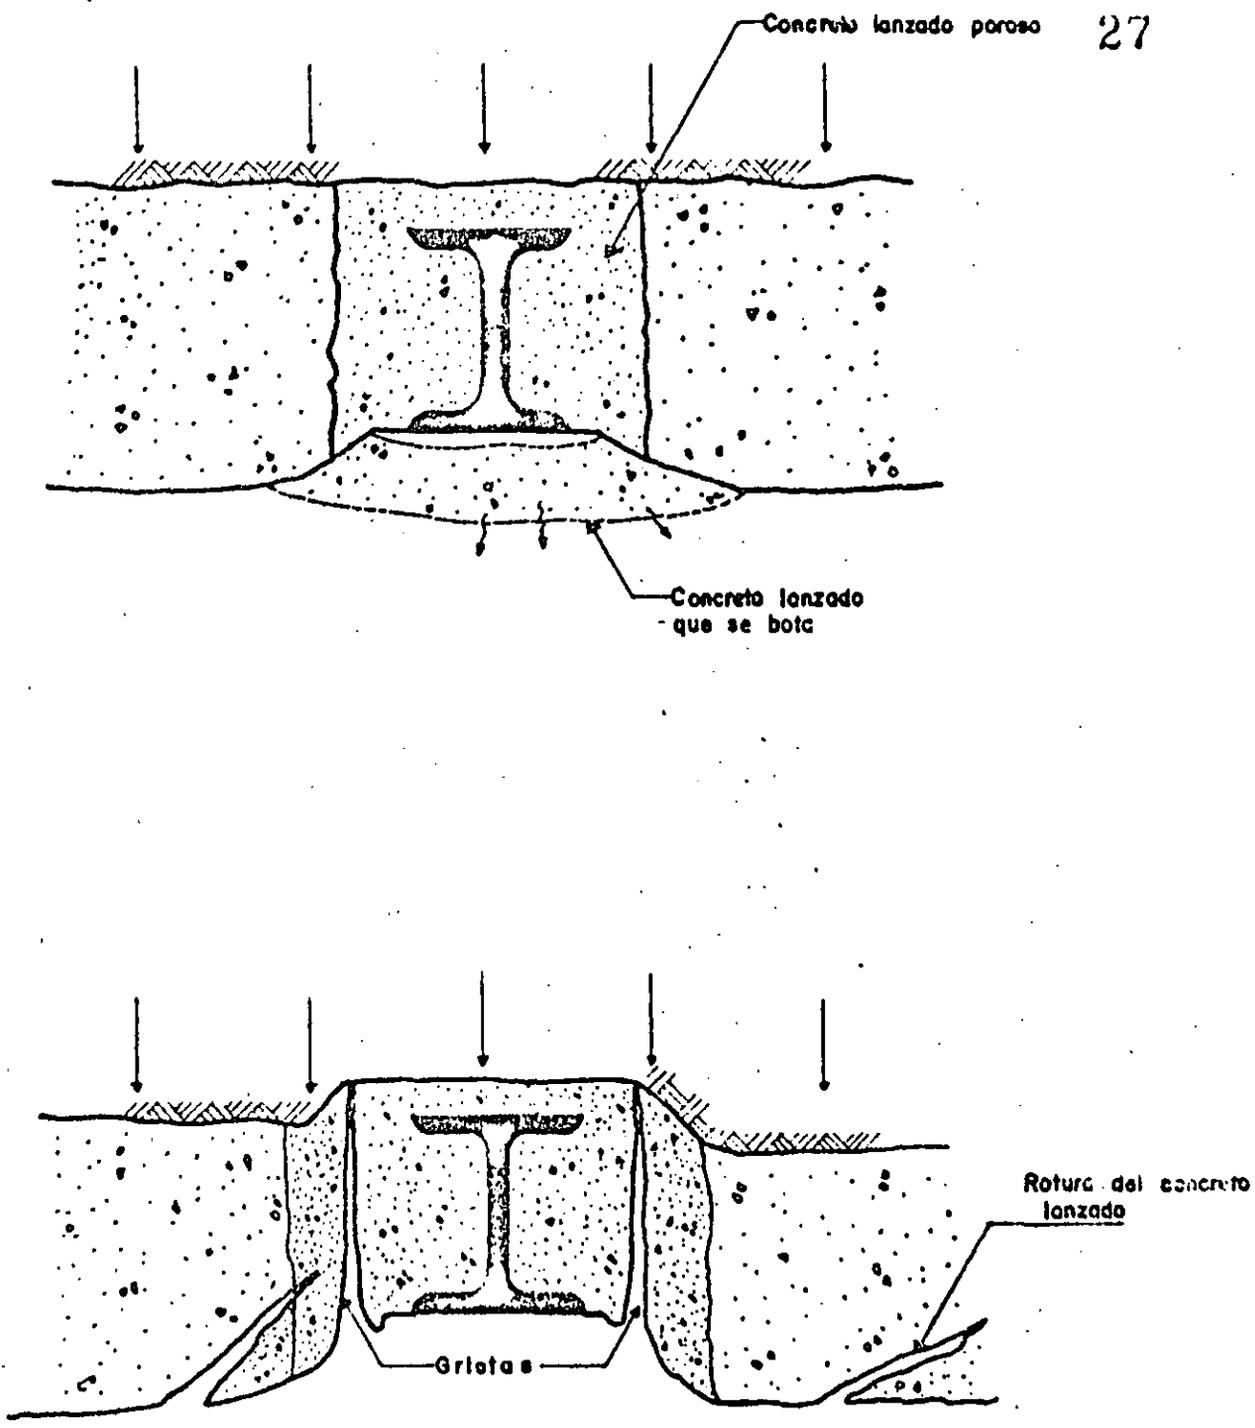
ROTURA DEL SISTEMA CONCRETO LANZADO-VIGUETAS DE ACERO
